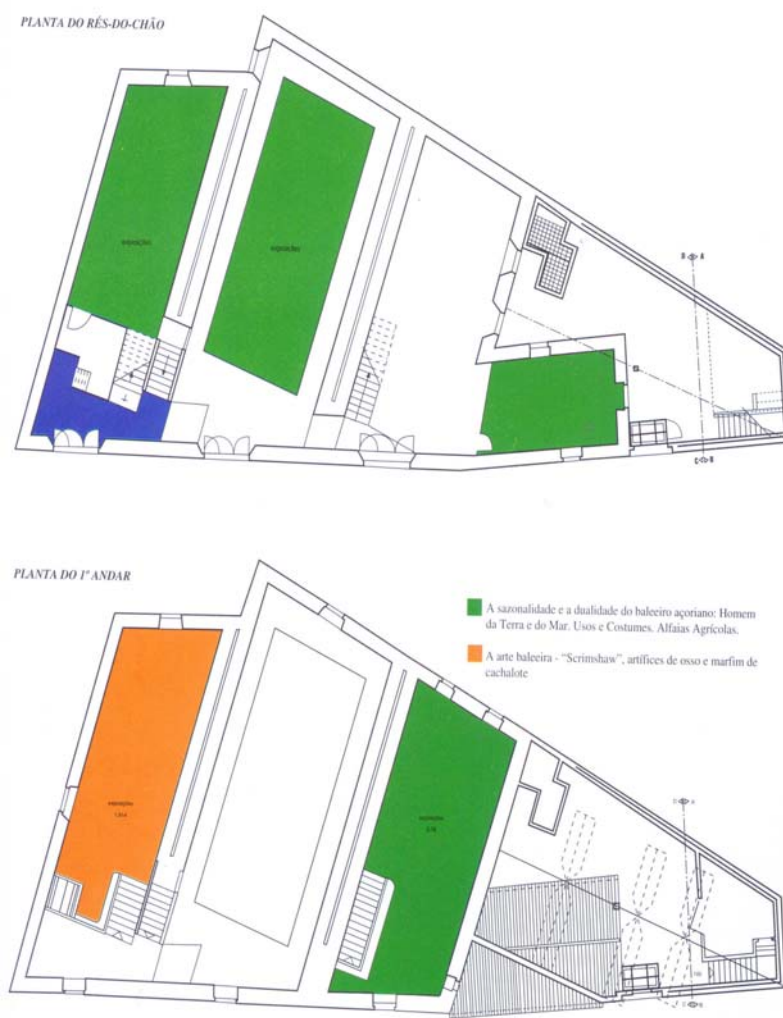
Planta Baixa Pavimento Térreo e Pavimento Superior
